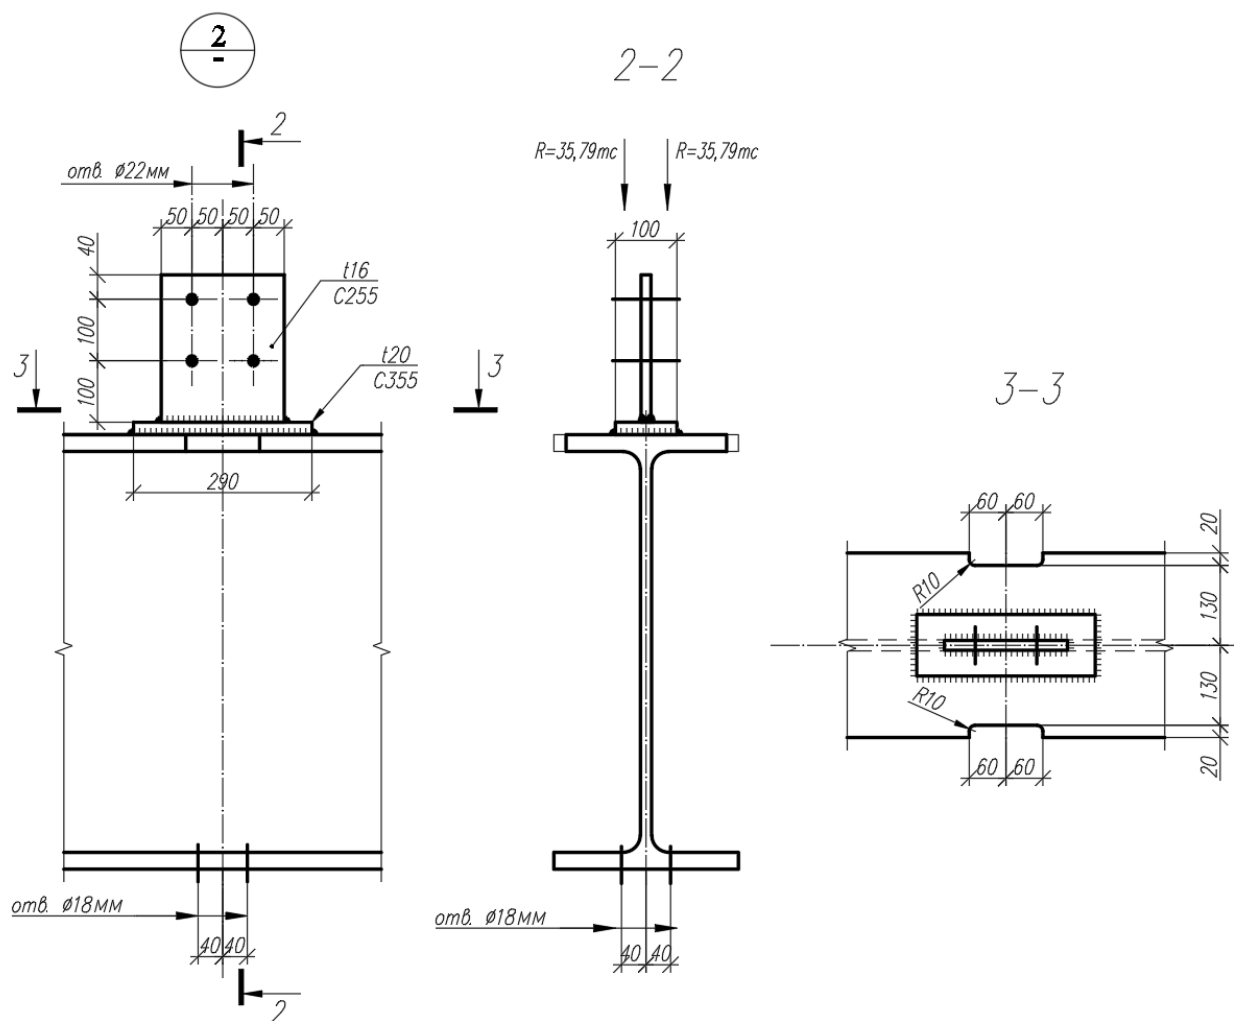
Узел 2 подстропильной балки БП-12-75.
